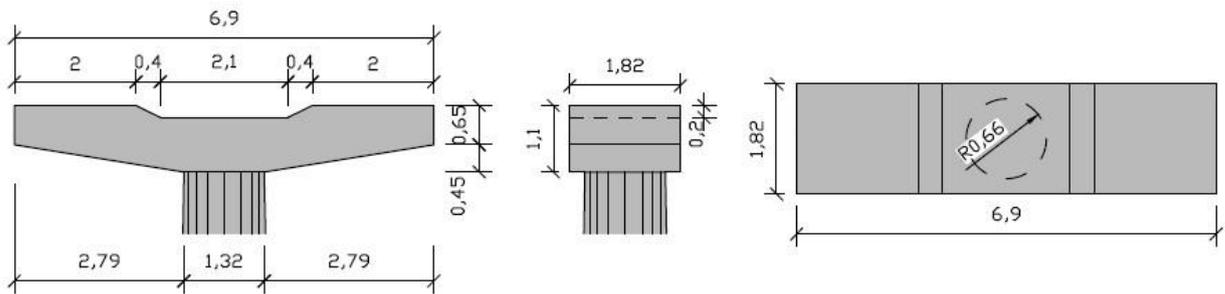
Detalle del cabezal de las pilas de los Pasos elevados. Sección transversal (izqda.), longitudinal (centro) y planta (dcha.)
